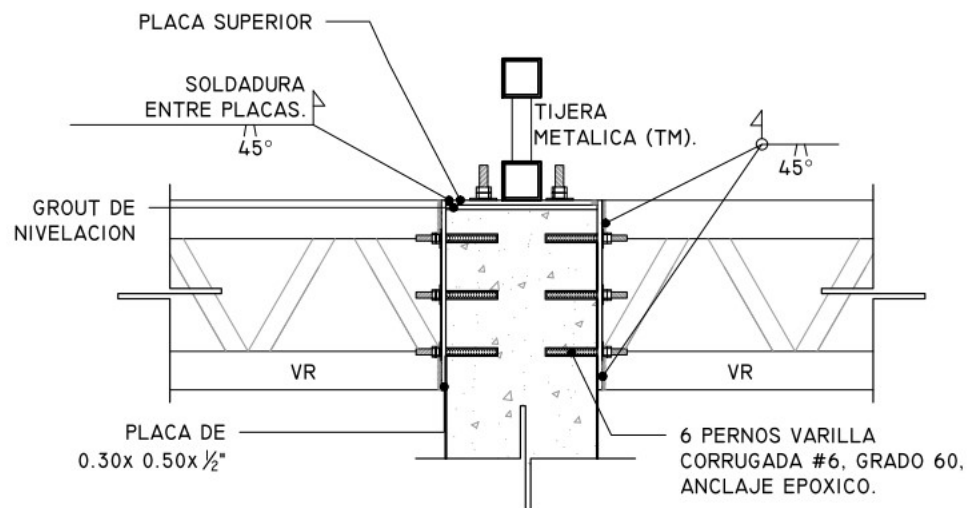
Columna de concreto existente dónde se apoya lateralmente las vigas re rigidez. Fuente: Elaboración propia.
